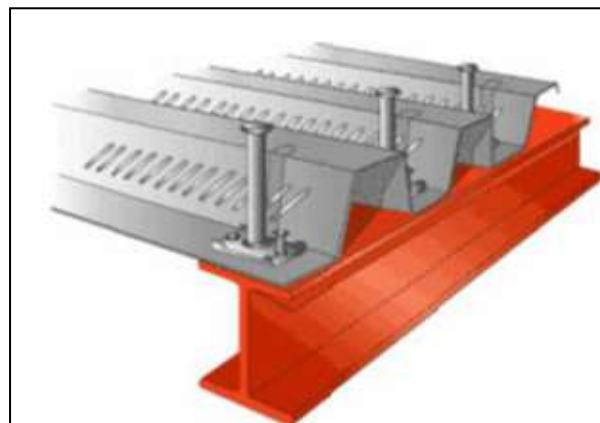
particolare dell'attacco fra trave HEA e lamiera grecata.
